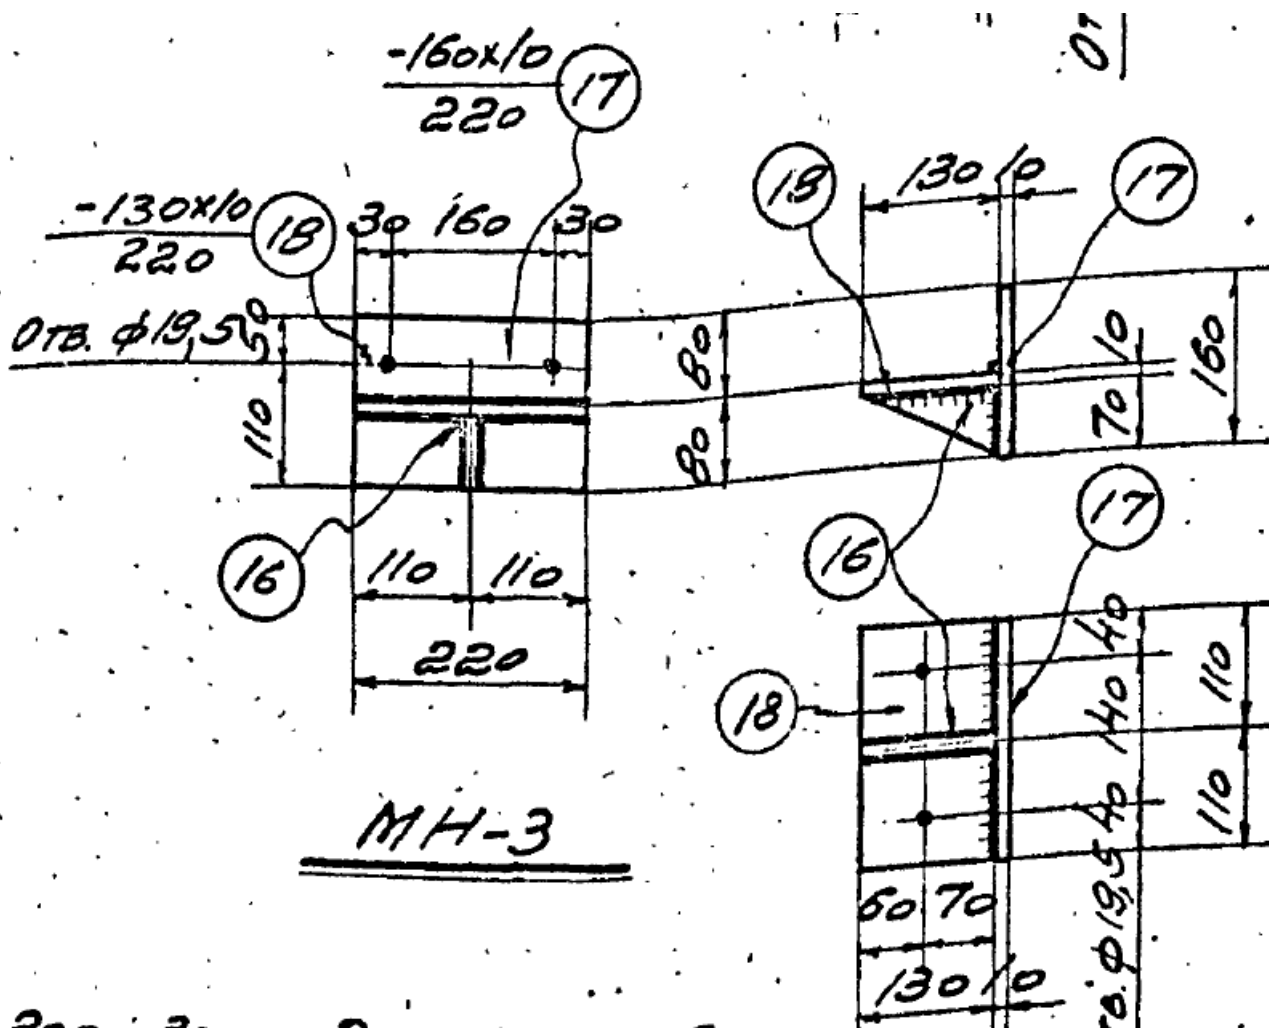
Детализированный чертёж существующей закладной детали в ферме ФС-1
